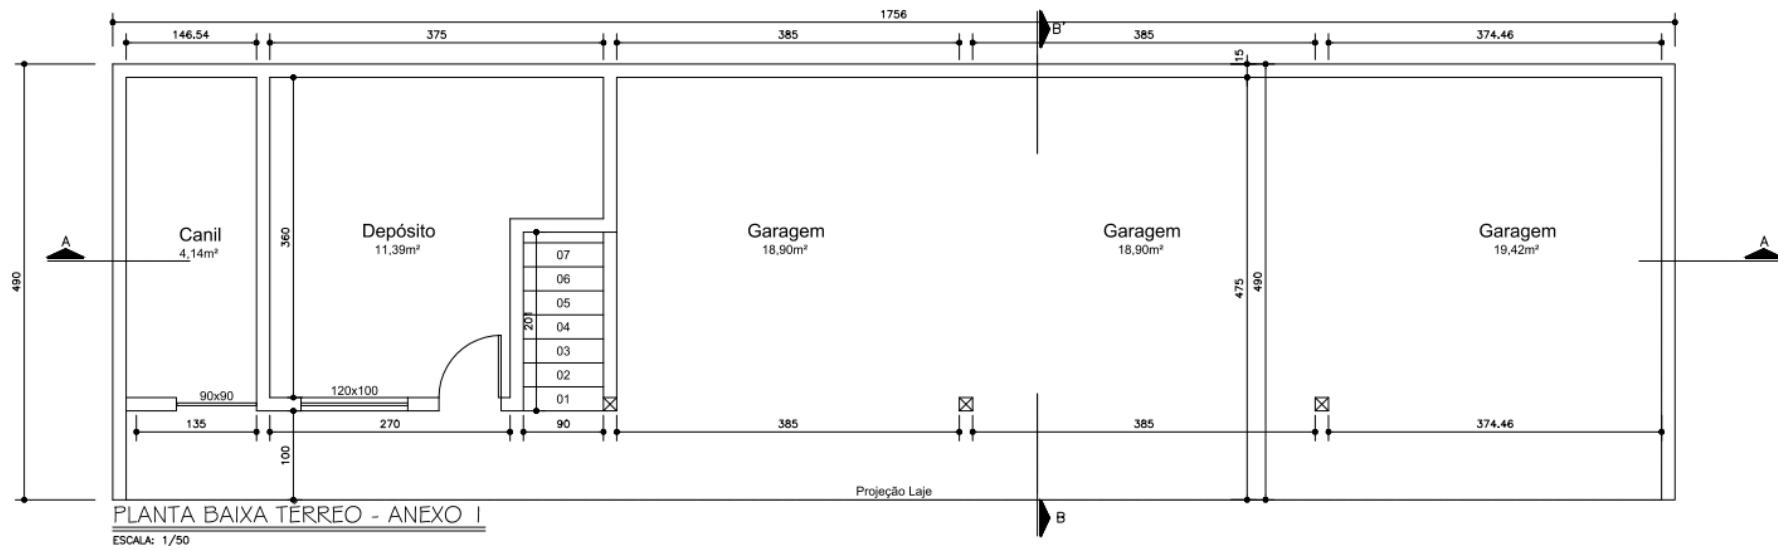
Planta baixa do Térreo do anteprojeto arquitetônico.
